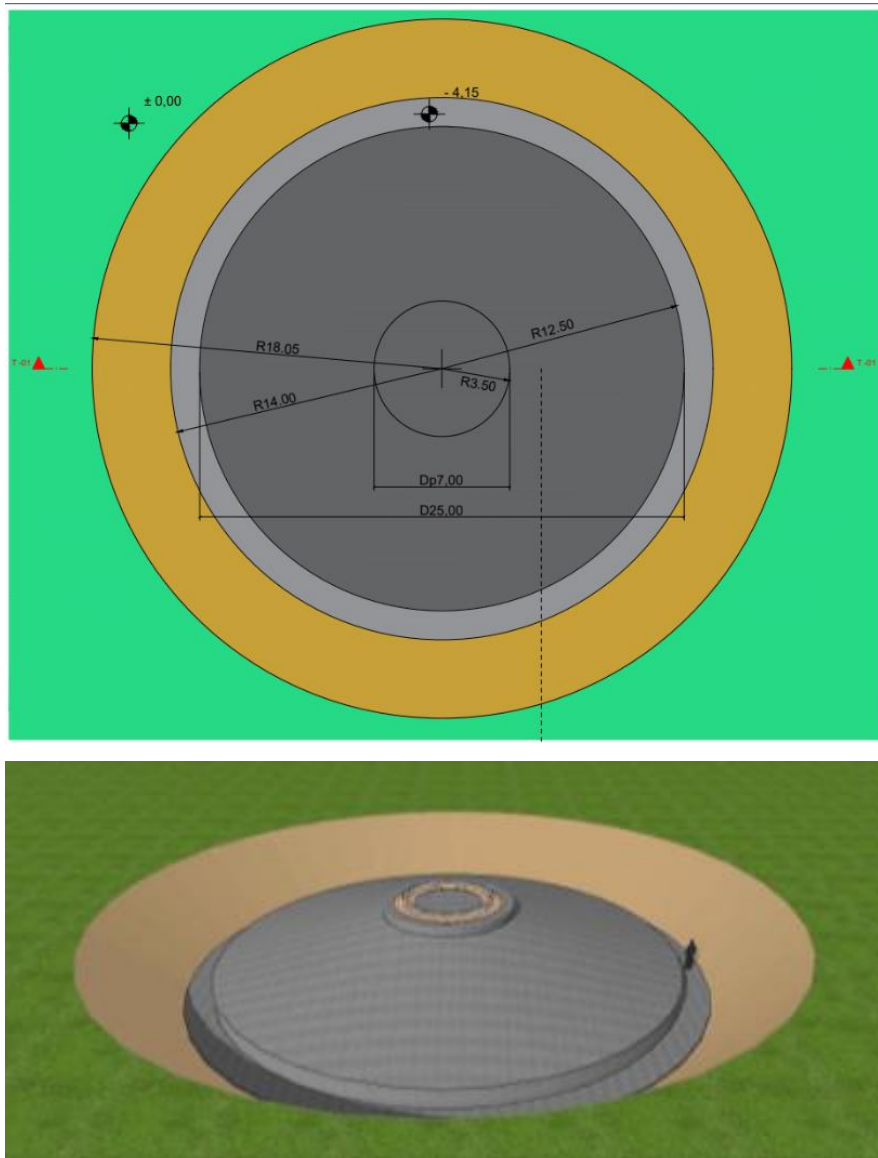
pianta e riproduzione 3D del plinto di fondazione
